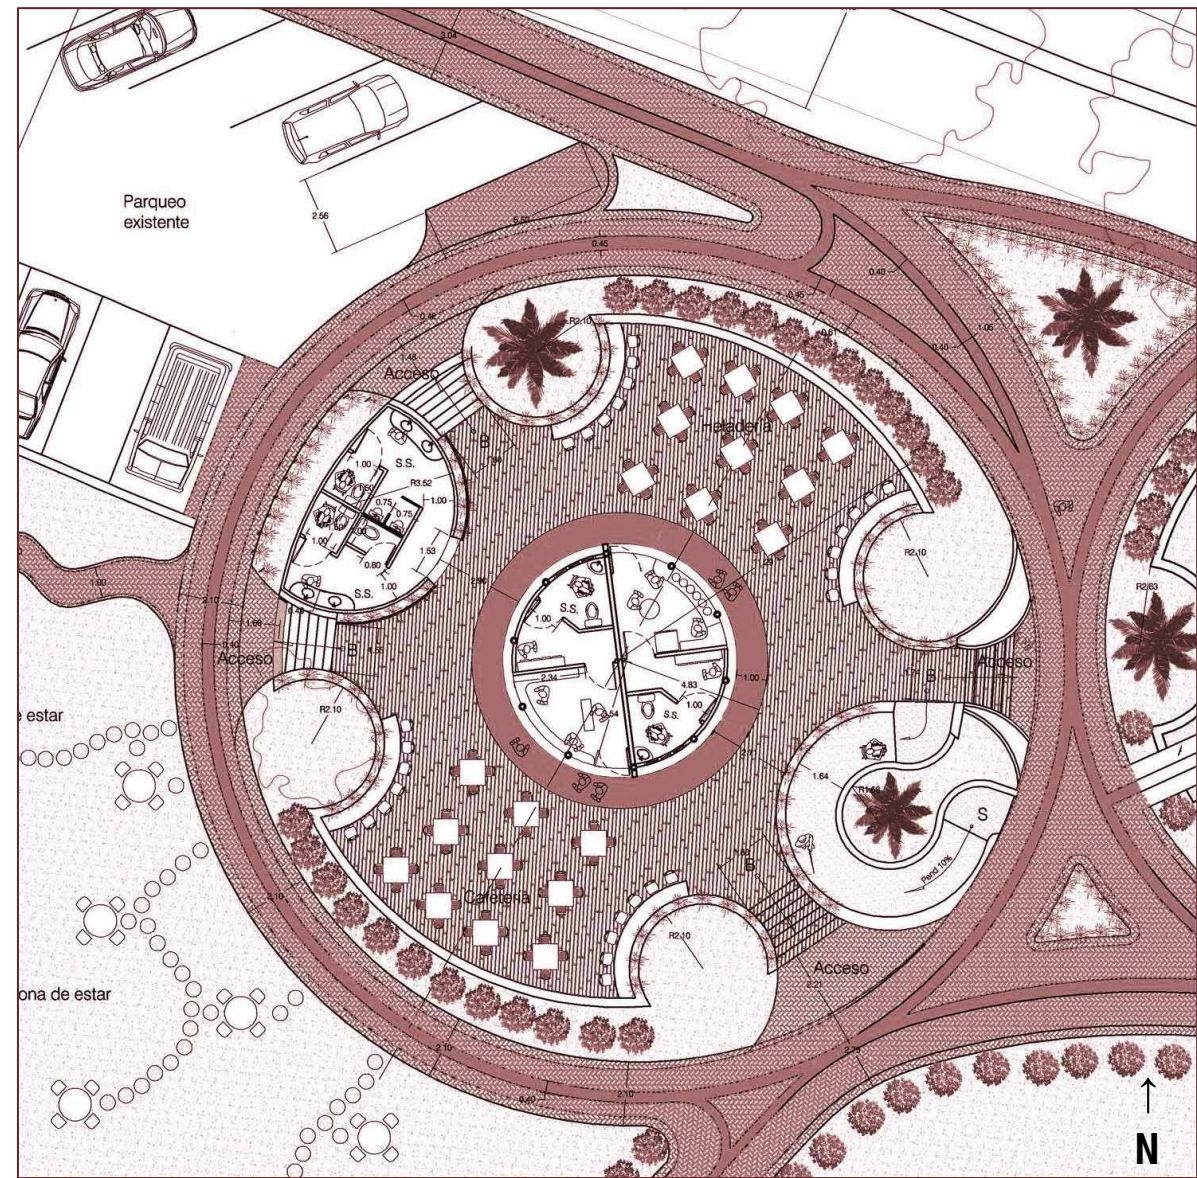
Módulo 1.Panta de distribución arquitectónica.
